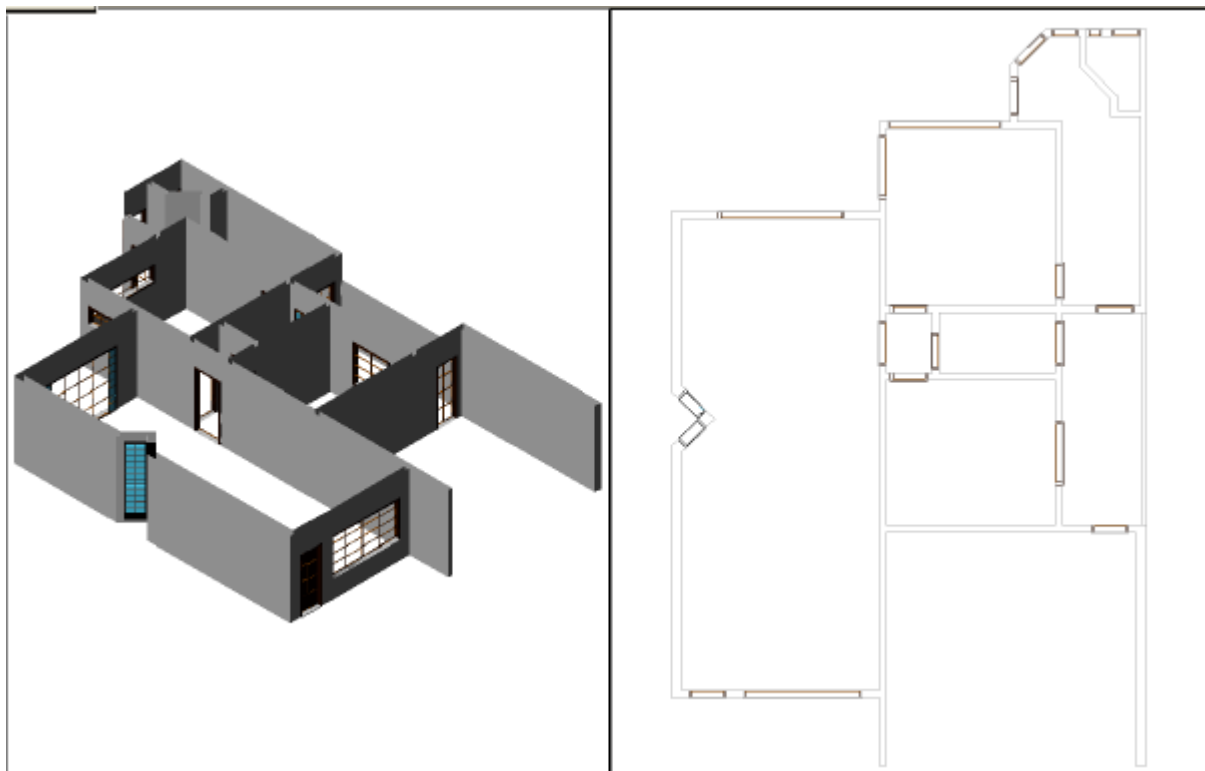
Layout (3D Shade e 2D) do primeiro pavimento com as esquadrias desenhadas
